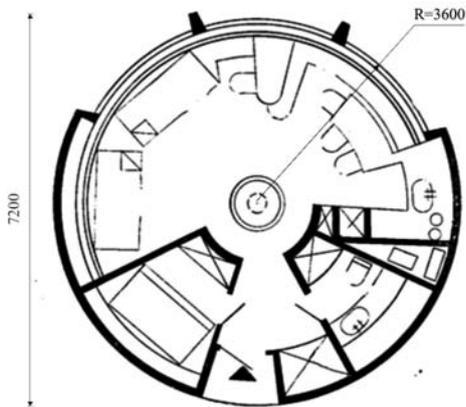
План домика круглой формы для отдыхающих. Арх. Кассони (Италия)
